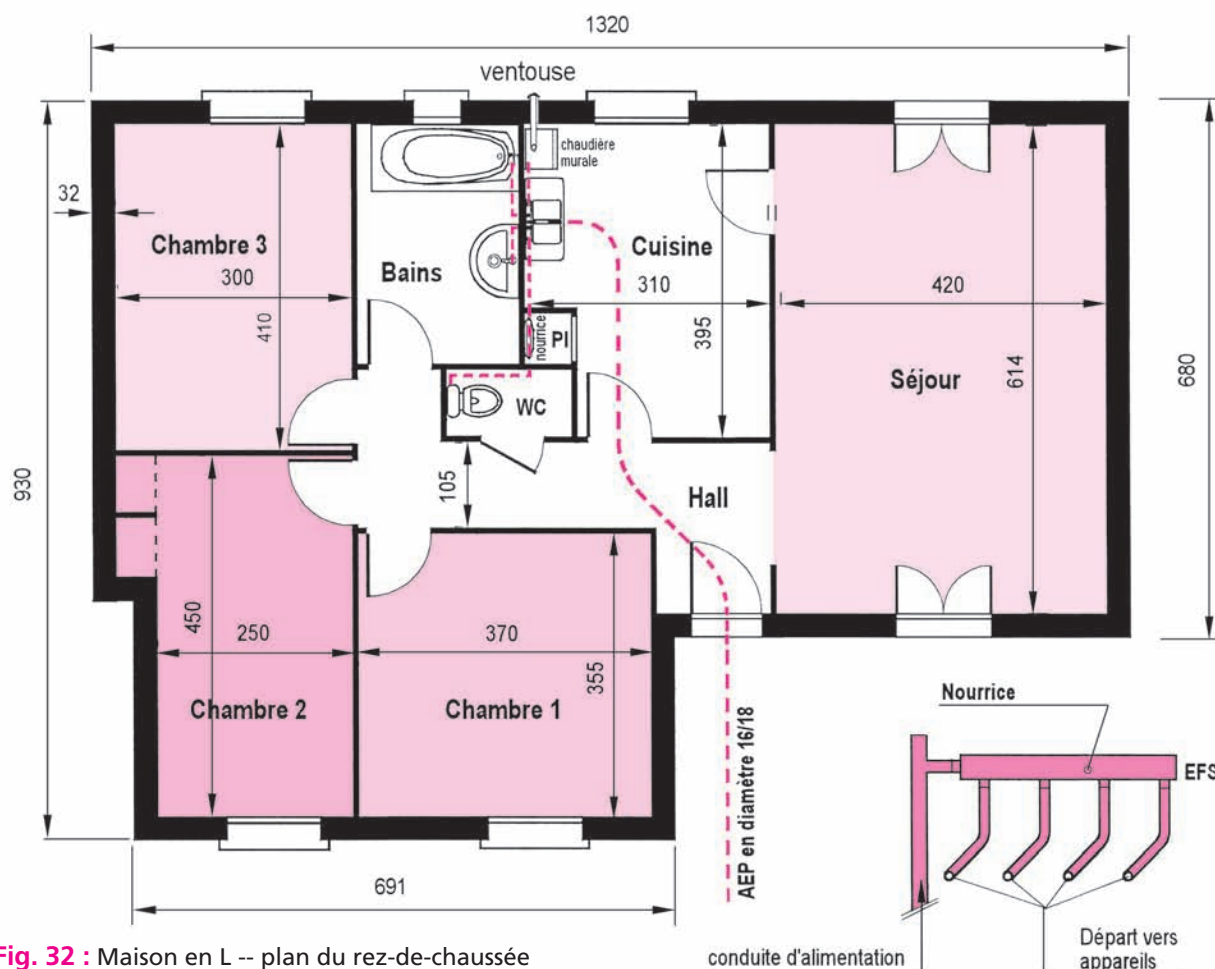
Maison en L -- plan du rez-de-chaussée
